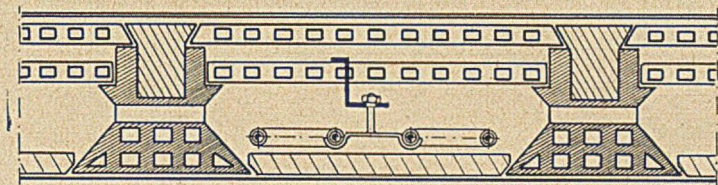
Ausführung einer Deckenheizung nach dem DRP. 639640.
